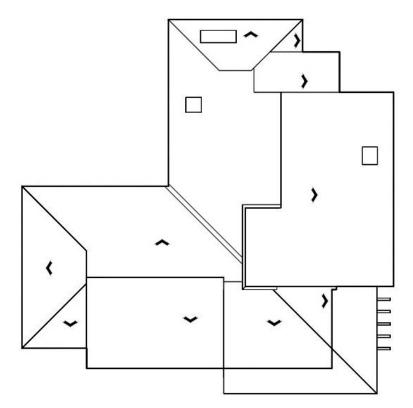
Planta de Cobertura Fonte: Projeto Arquitetônico (2017)
